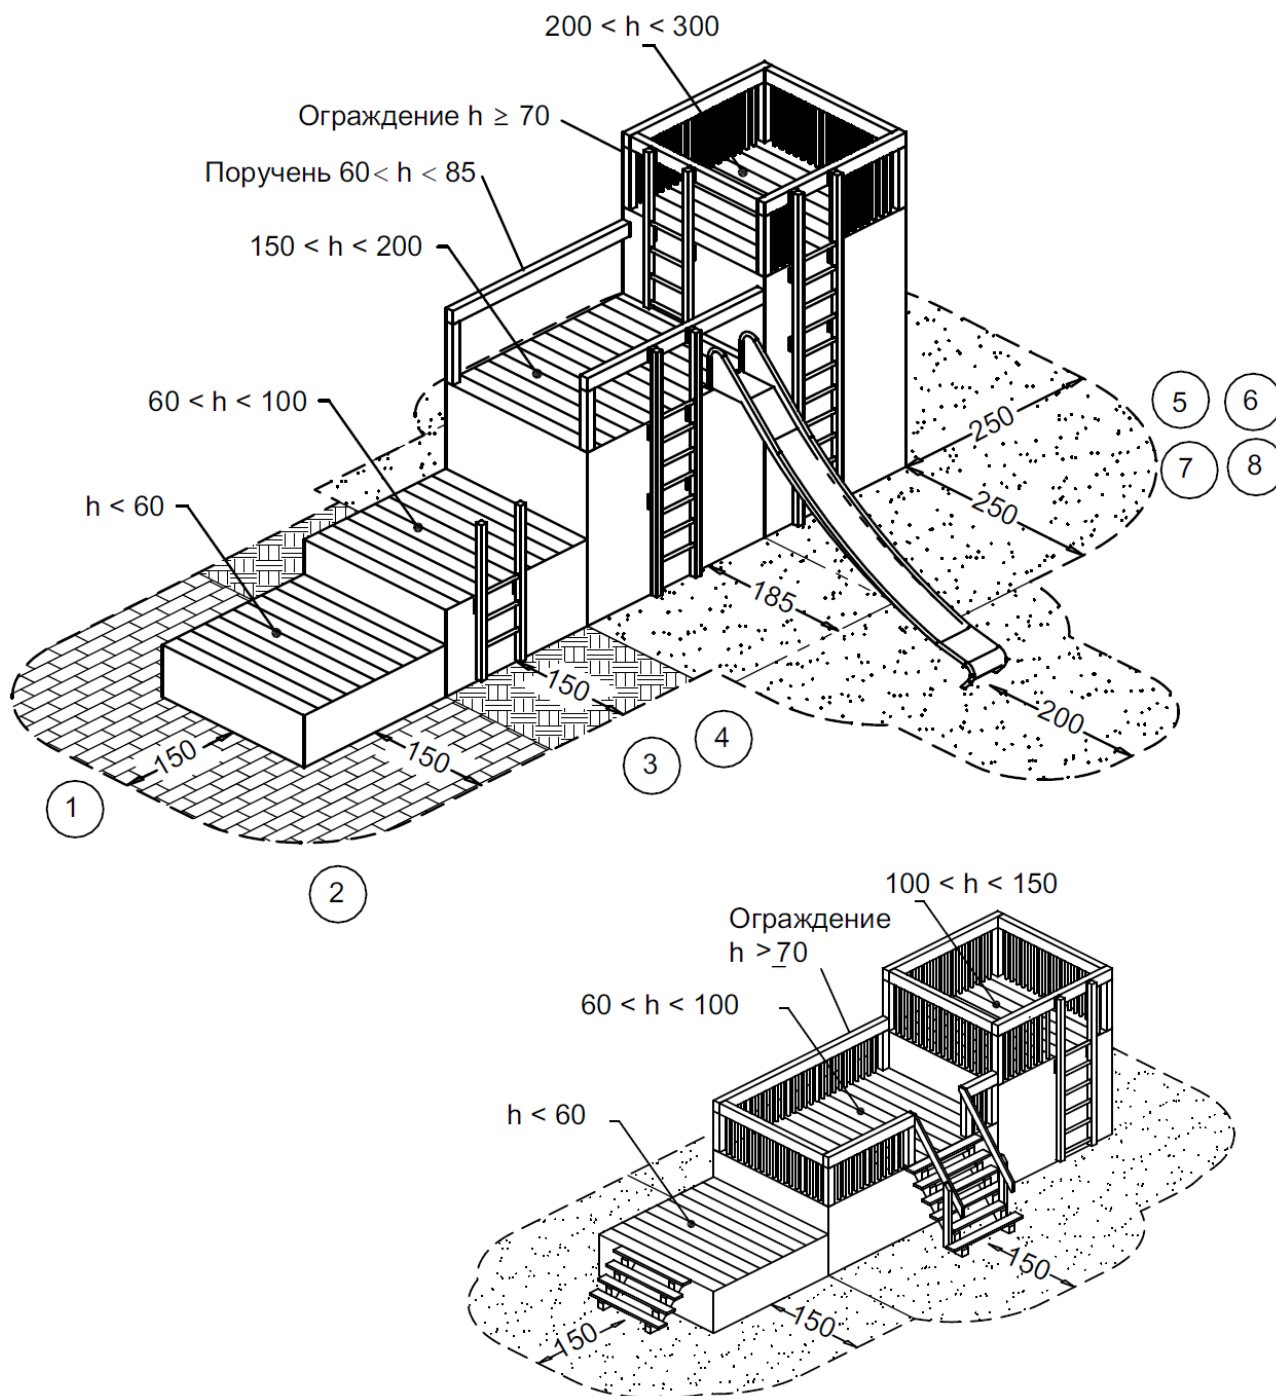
Зоны безопасности детских игровых элементов. 1 – Бетонное, каменное покрытие. 2 – Асфальтобетонное покрытие. 3 – Грунтовое покрытие. 4 – Газонное, травяное покрытие. 5 – Мульчирование корой, фракция 20–80 мм. 6 – Деревянная щепа, фракция 5–30 мм. 7, 8 – Песочное покрытие (фракция 0,2–2 мм), покрытие из мелкого гравия (2–8 мм), без примесей и глиняных включений.
